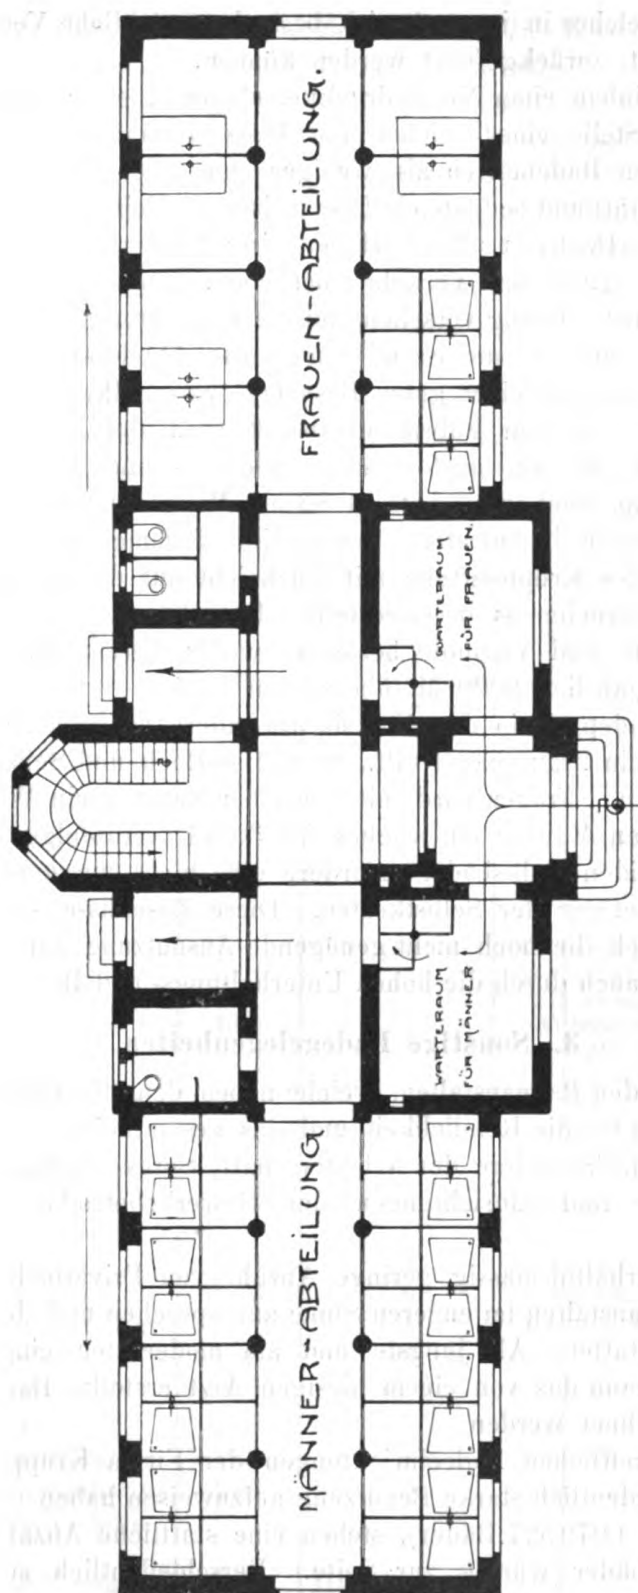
Grundriss des Volksbrausebades II an der Söllingstrasse.
